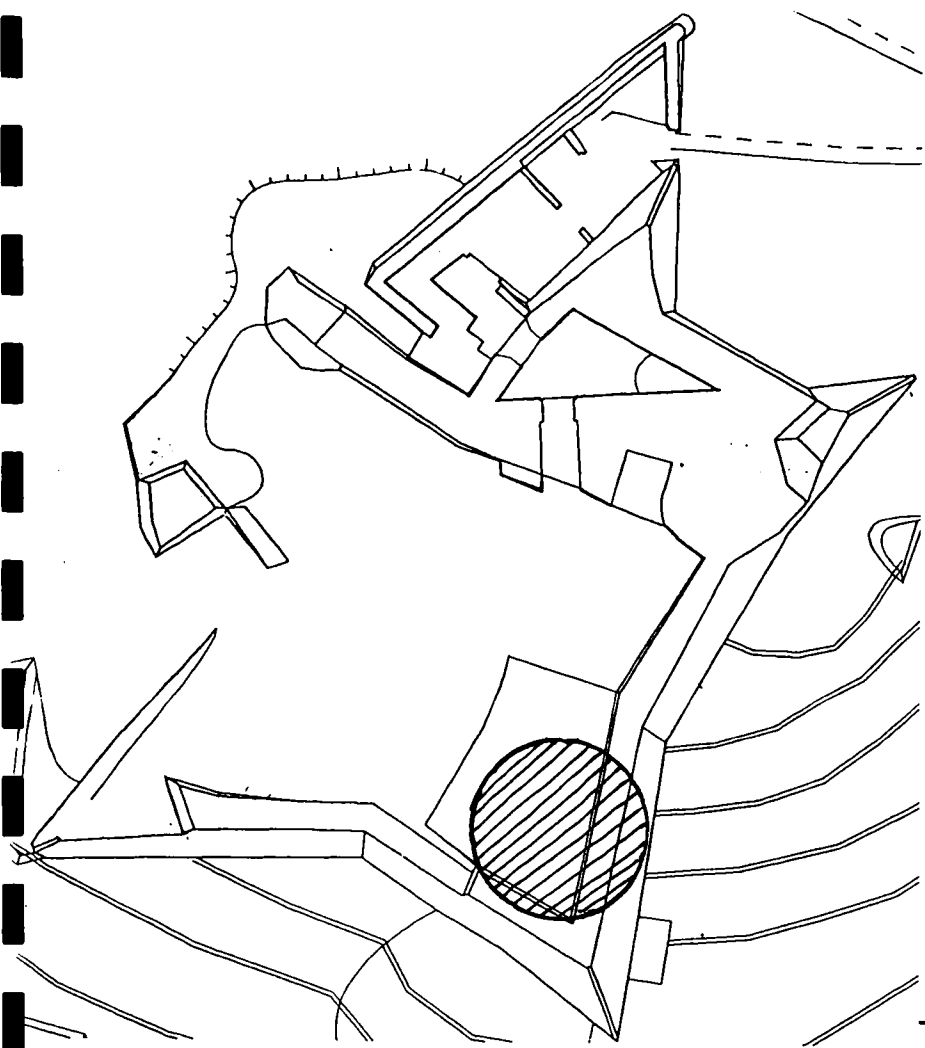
Croquis - Planta sota subterrània, punta SE.
